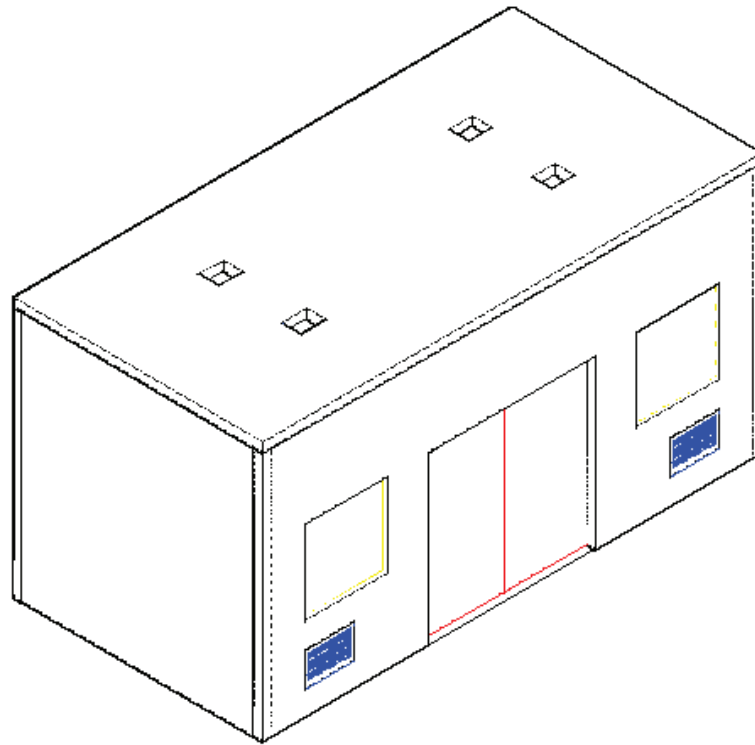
Vista tridimensional del sistema de encapsulamiento de la cabina de molinos
